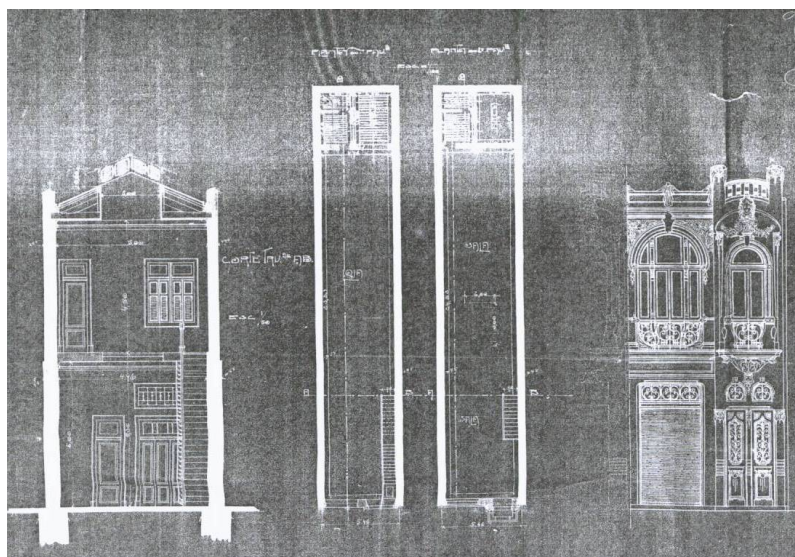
Corte plantas, 1º e 2º pavimento fachada Hermanno da Silva Ramos
